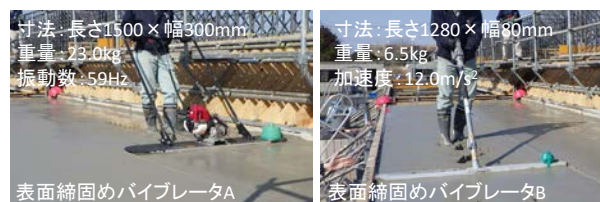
試験体の概要(寸法, 配筋, 表面締固め)¹⁾写真-2 表面締固めバイブレータの使用状況¹⁾
